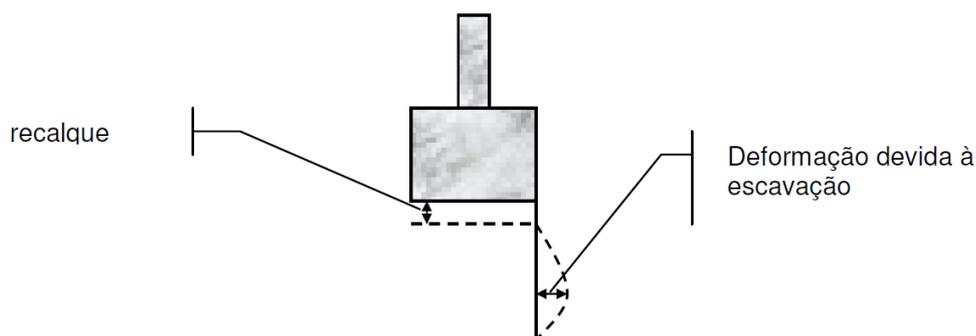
Recalque de fundação proveniente da deformação do solo devido à escavação (DAL MOLIN, 1988).
